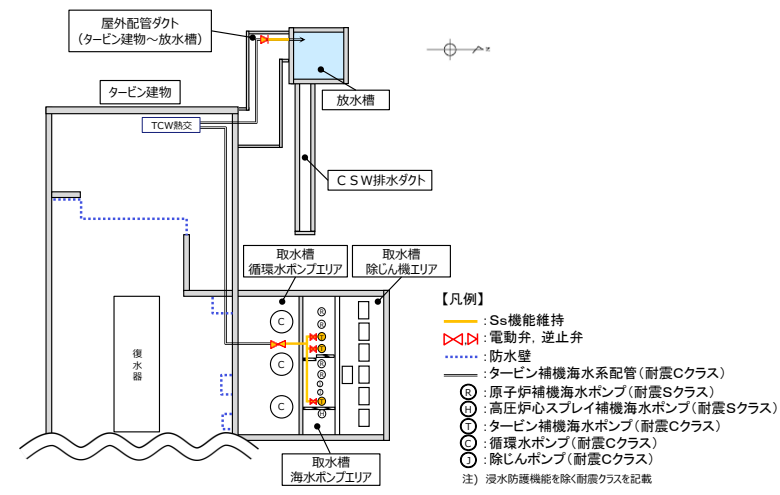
タービン補機海水系の対策概要 (平面図)
